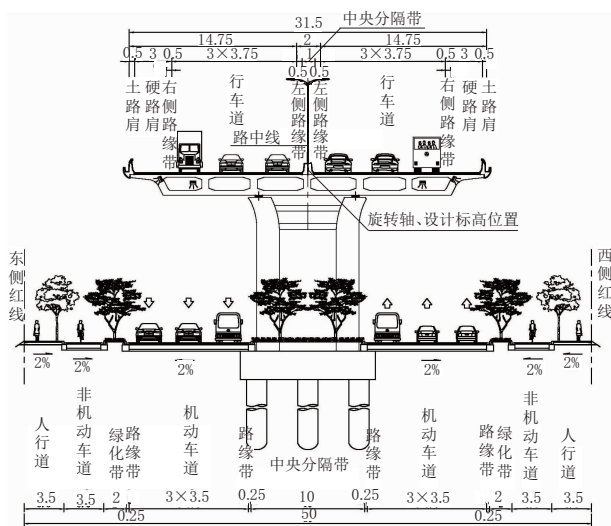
福宜高速城区段宽 50 m 标准横断面图(单位:m)
